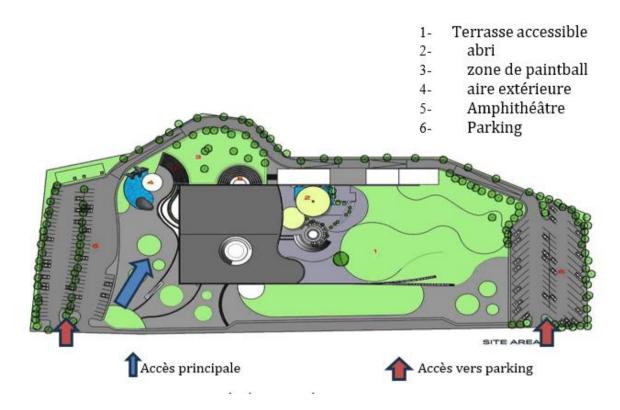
Plan de masse Antalya aquarium Source : www.archdaily.com+Traitement : auteur -Plan de rez de chaussée :
